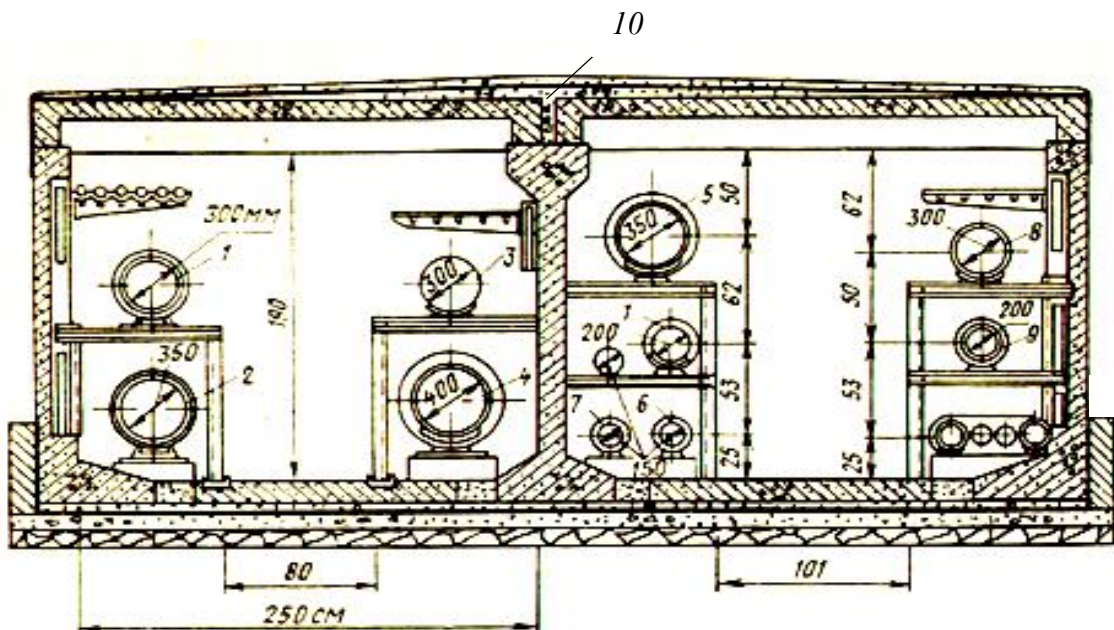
Двухсекционный коллектор: 1 – паропровод; 2 – резервный паропровод; 3 – воздухопровод; 4 – линия теплосети; 5 – водопровод; 6 – обратная линия теплосети; 7 – вентиляция; 8 – горячая вода; 9 – трубопровод горячей воды; 10 – гидроизоляция коллектора
